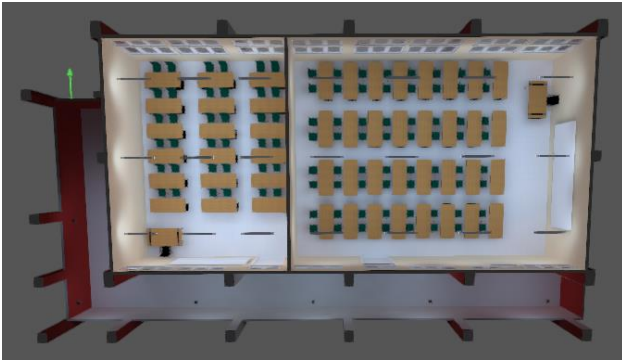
Gedung B lantai 1 Teknik Arsitektur
